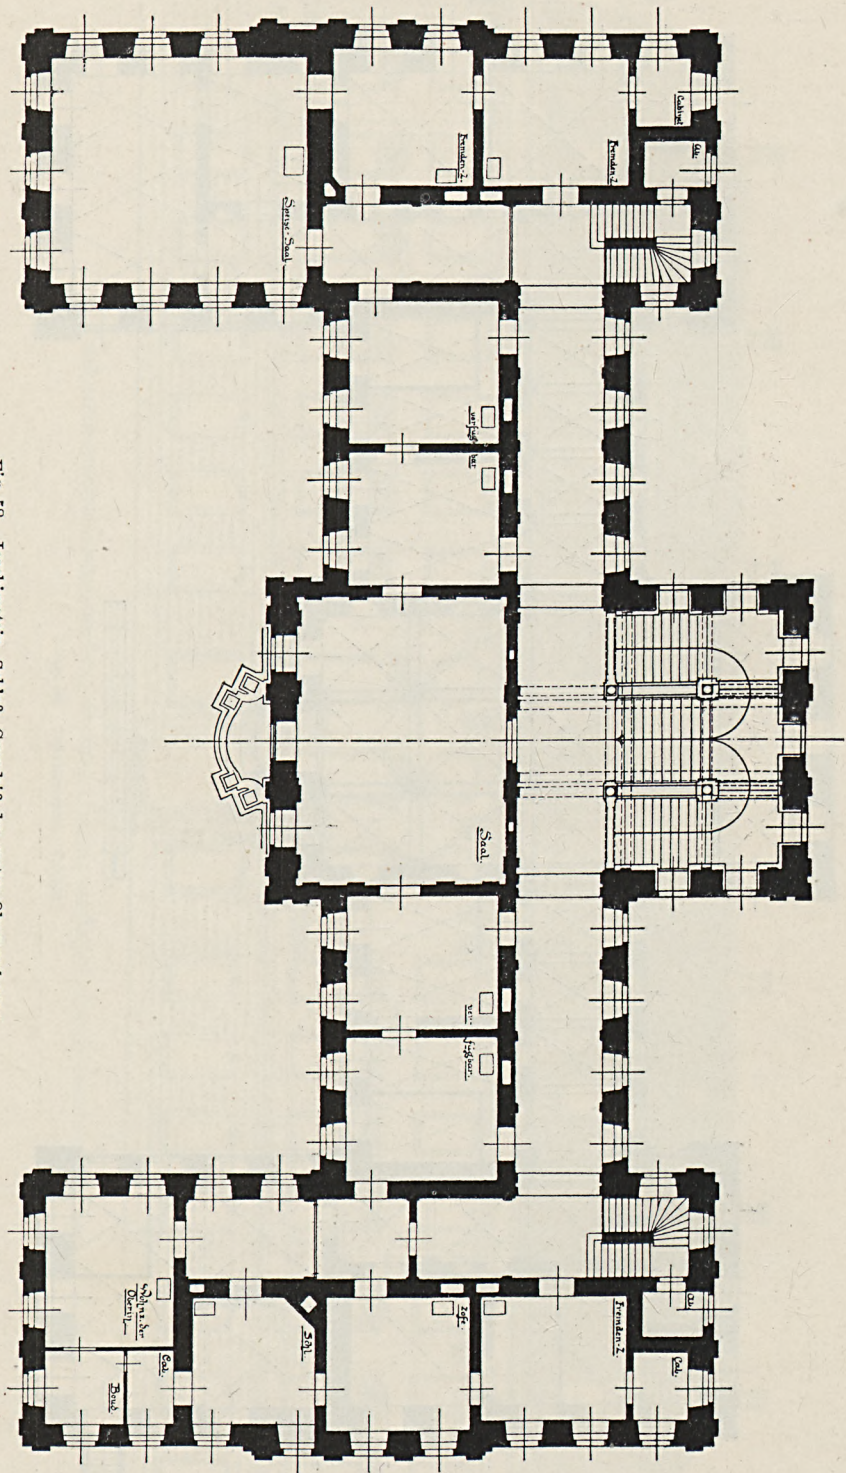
Joachimstein, Schloß, Grundriß des ersten Obergeschosses.
